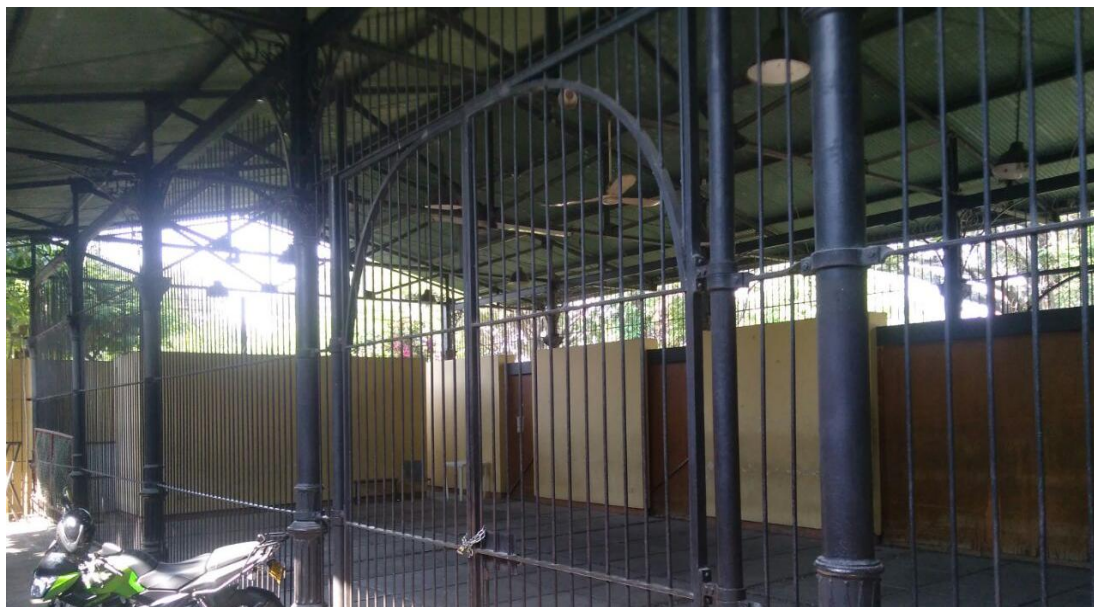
Volumetría del inmueble después del incendio - Fachada 3 y 4
